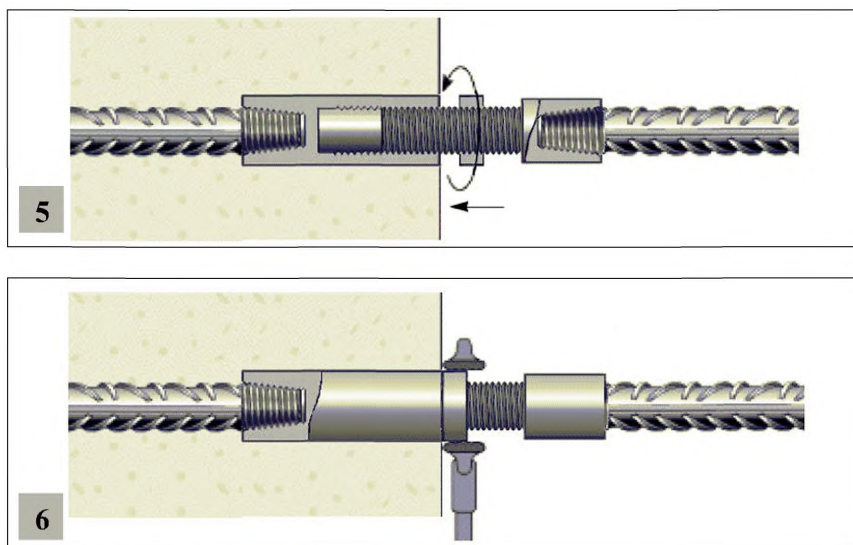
Сборка позиционного соединения тип 1 с конической резьбой
